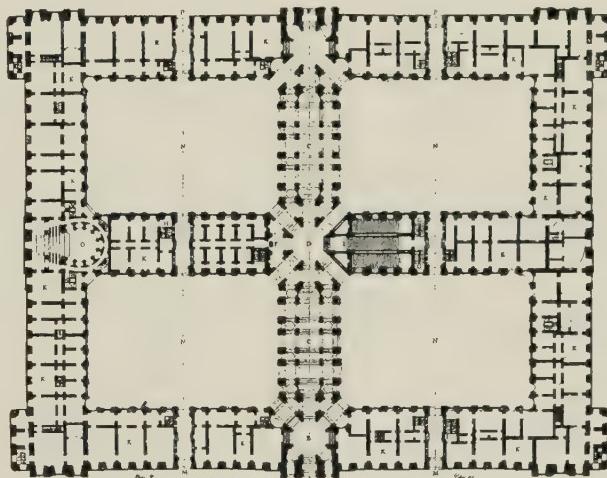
Schloß zu Caserta Grundrisse
